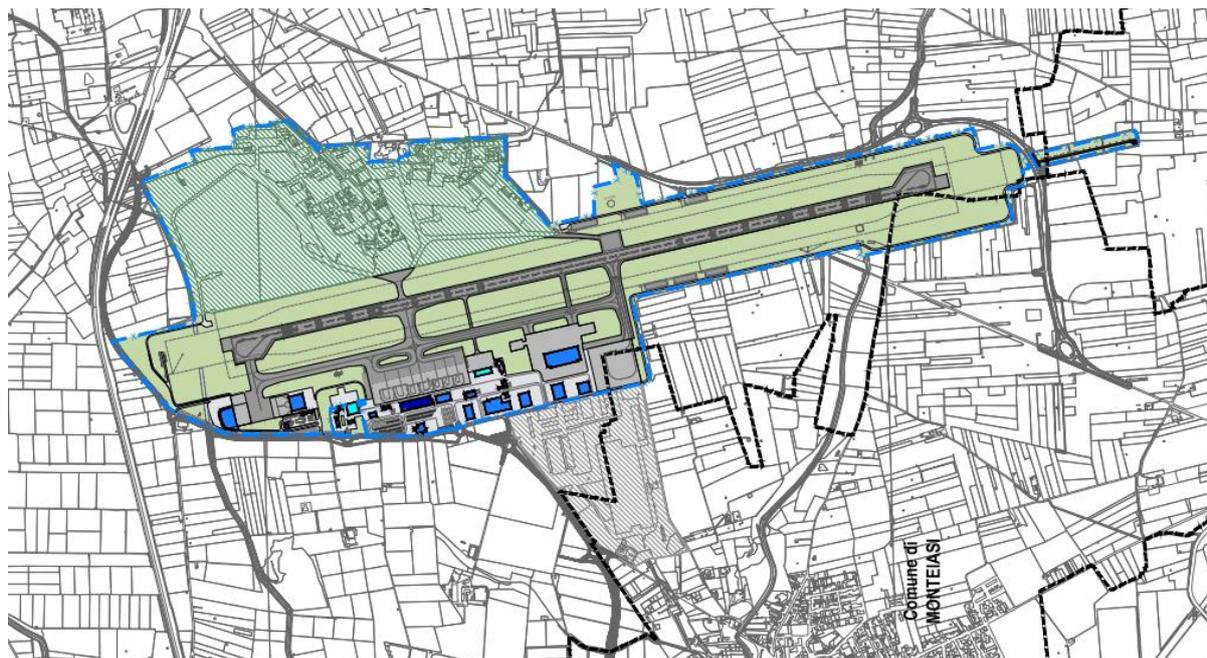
Configurazione finale dell'aeroporto secondo il layout infrastrutturale individuato dal PSA
